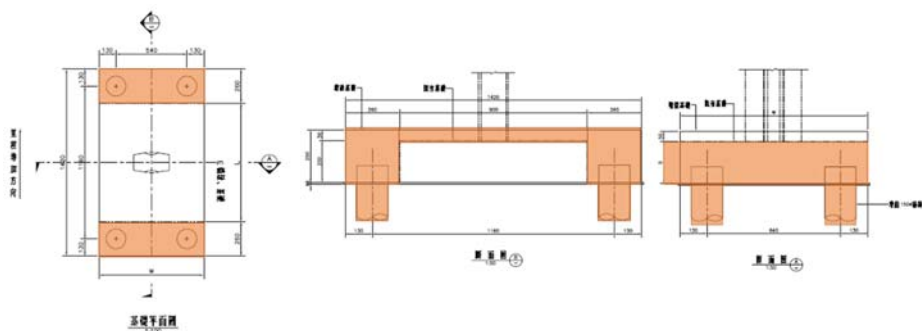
和美交流道匝道一高架橋 P113 基礎補強示意圖
